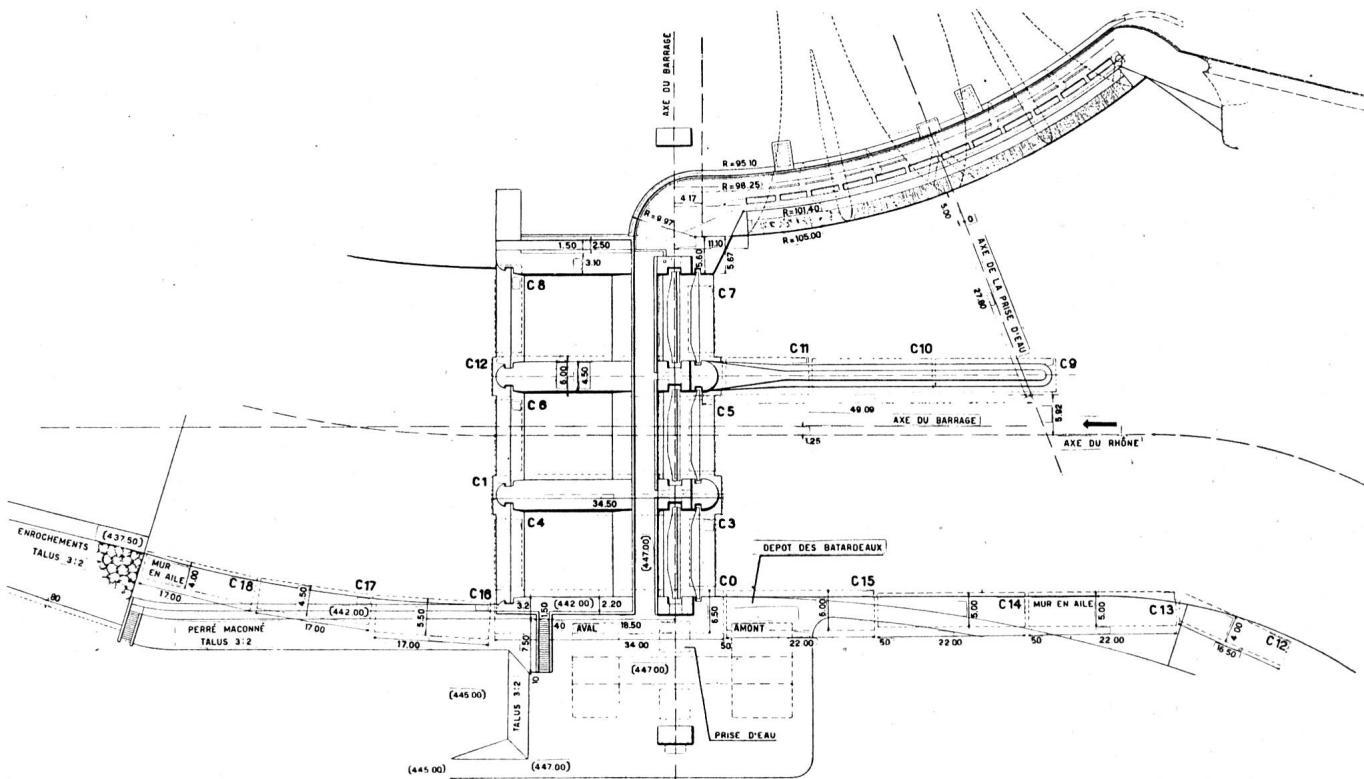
Barrage et prise d'eau, plan général. Echelle 1:1200.
